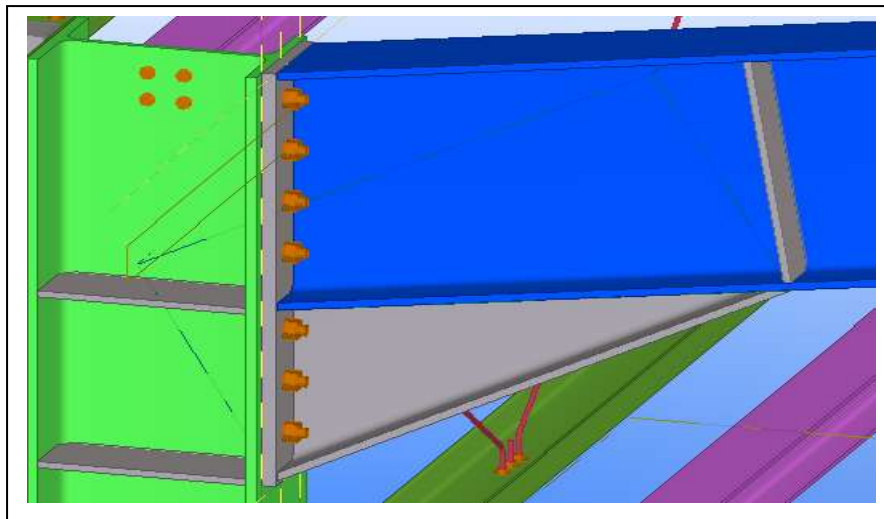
Représentation de l'assemblage poteau-travers.
